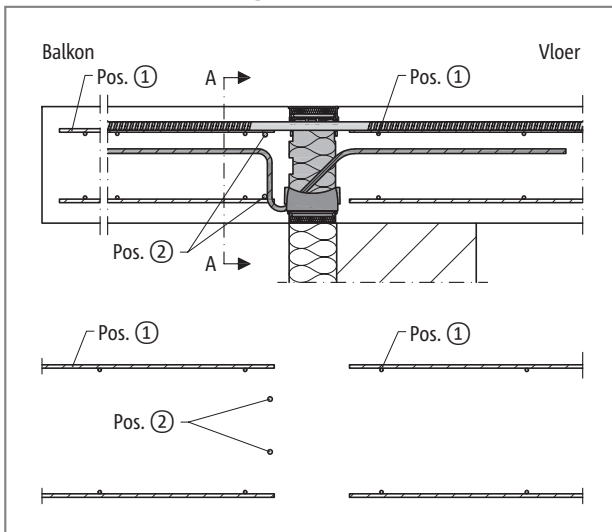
Schöck Isokorb® CT type K-T-M6 bij R0: doorsnede
